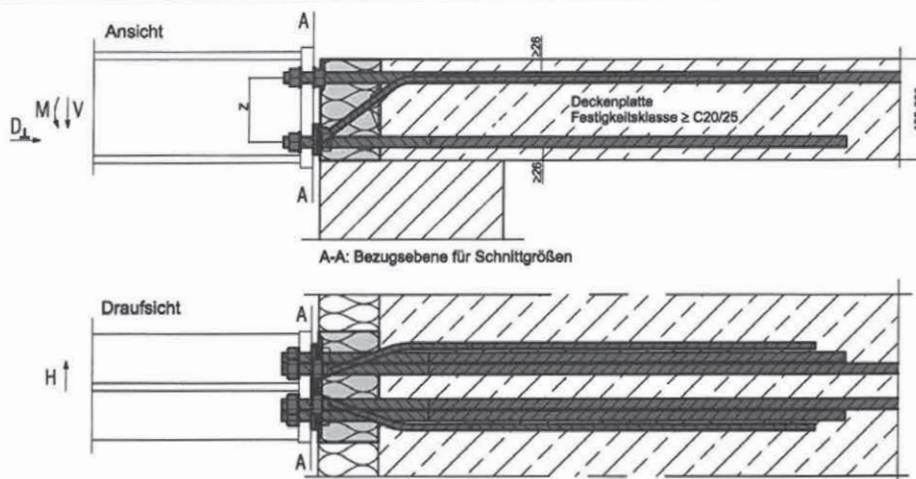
und 74: Schöck Isokorb® Typ KSXT20 V12, Schnittgrößendefinition
